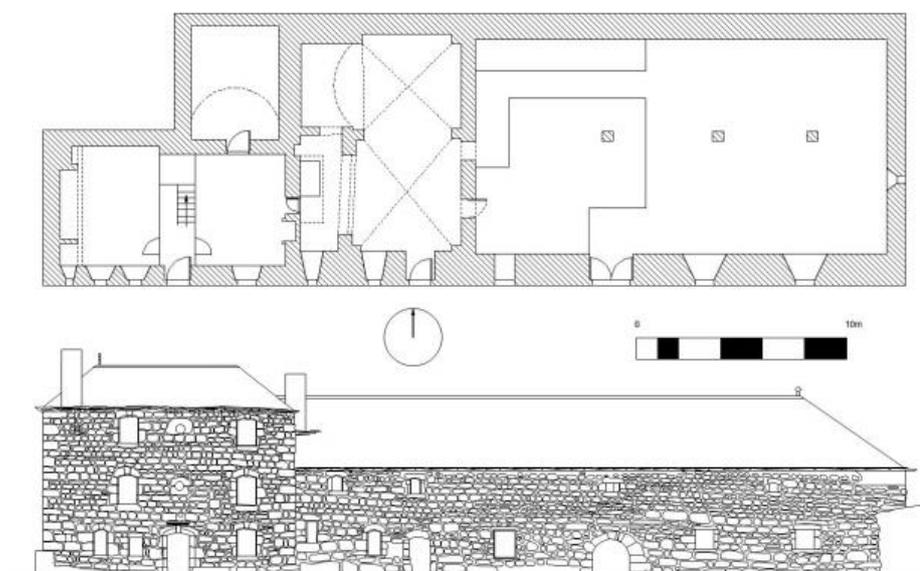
Plan et relevé pierre à pierre de la Besse, Usclades-et-Rieutord (07)
